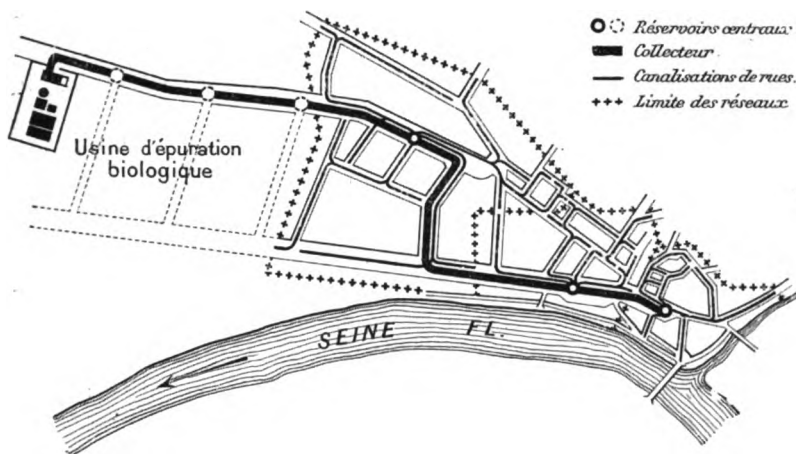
Plan général d'assainissement de Villeneuve-Saint-Georges.
